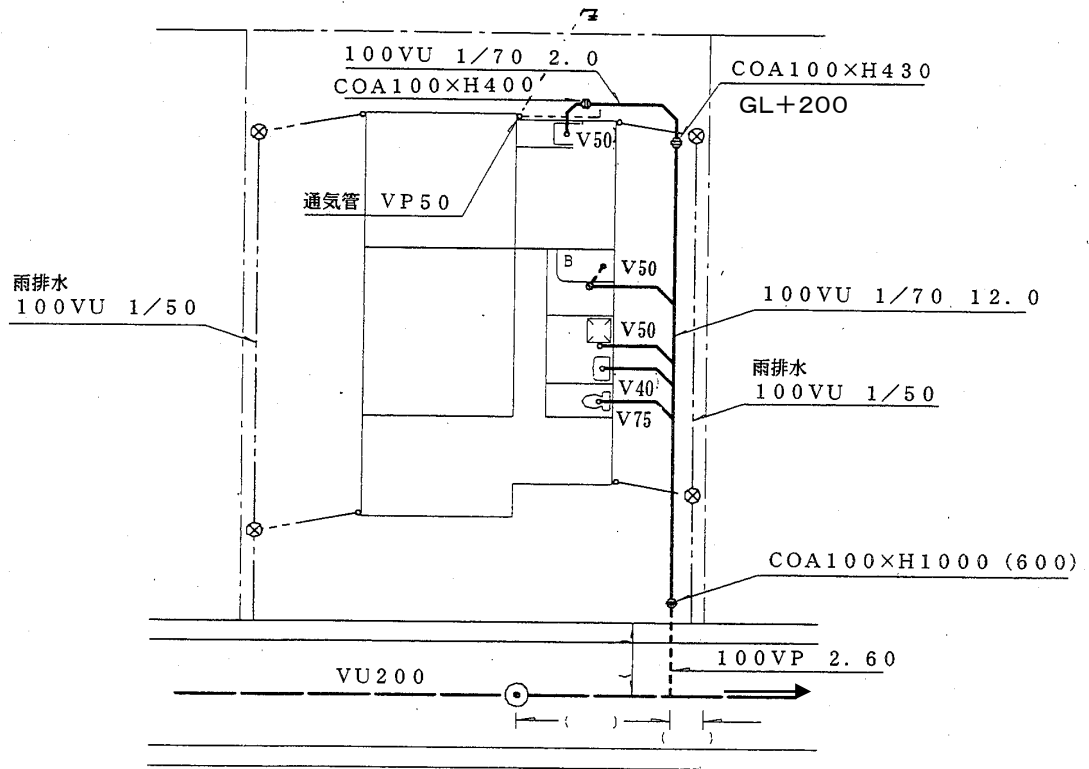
排水設備標準図 (例 1) 平面図縮尺 1/200
